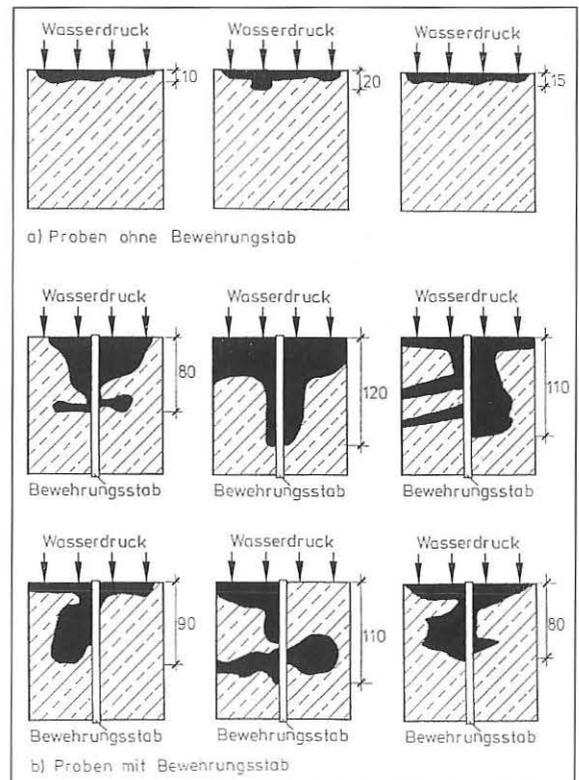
Ergebnisse der Wasserdurchlässigkeitsprüfung von Spritzbetonproben ohne und mit Bewehrung (Die Achse der Spritzbetondüse wurde parallel zum Bewehrungsstab ausgerichtet, um möglichst wenig Spritzschatten zu erhalten)
